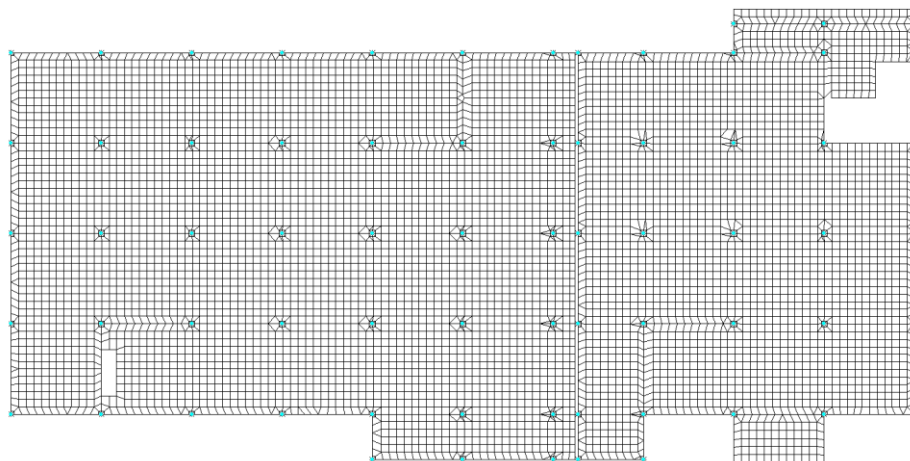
Расчетная схема монолитной плиты перекрытия на отм. +5,050
